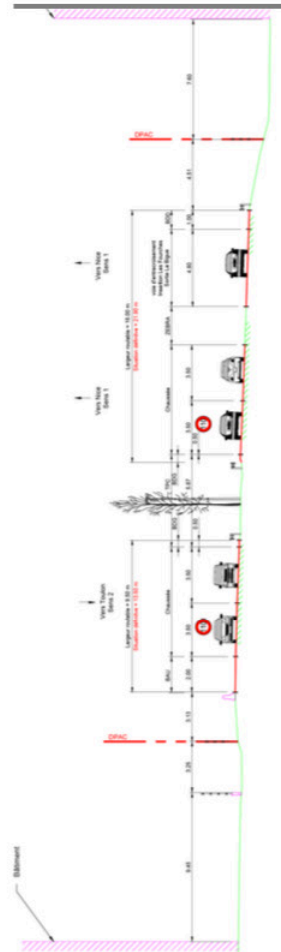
Profil en travers de l'A57 entre Les Fourches et La Bigue
